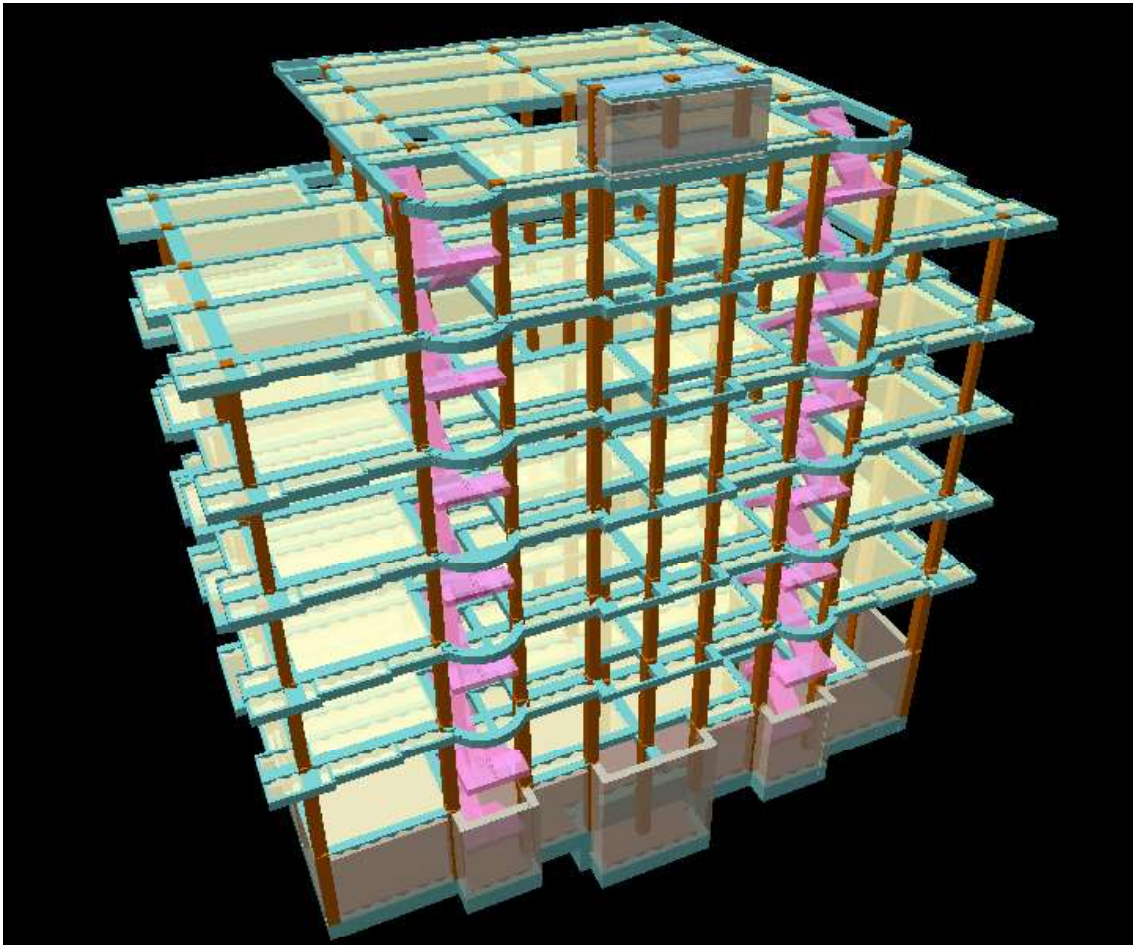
VISTA 3D DEL EDIFICIO
